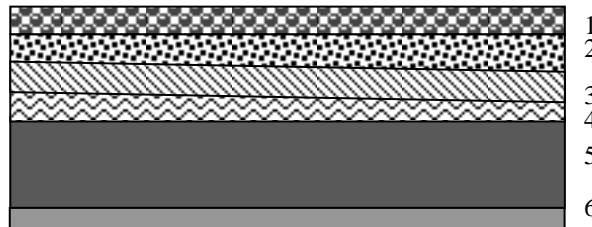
Coupe verticale du plancher terrasse à dalle pleine.
